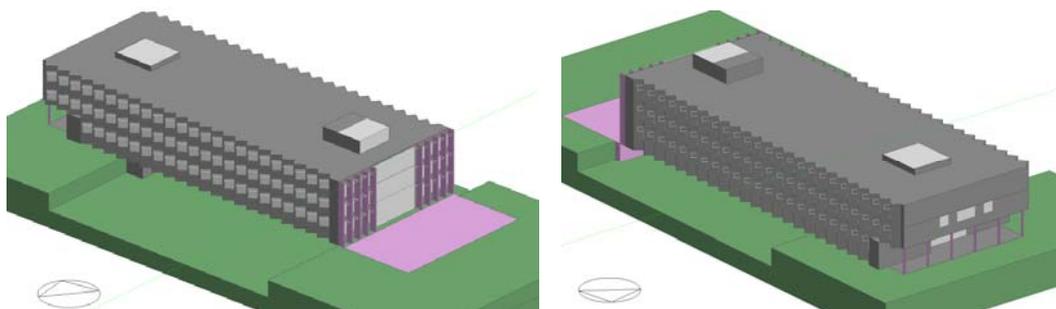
La modelización del edificio incluye la forma en zigzag de las fachadas este y oeste, y las protecciones solares de las ventanas. La fachada sur dispone de un muro cortina con fachada de doble piel y de ventanas protegidas con aleros y faldones; la fachada Norte posee muy pocas superficies acristaladas
